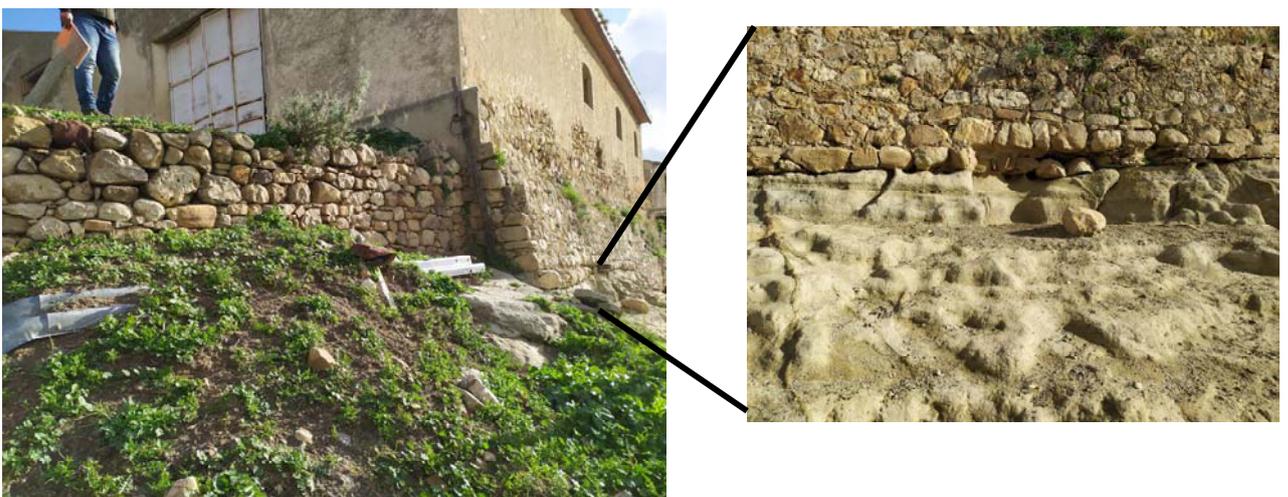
foto del terreno di fondazione e relativo dettaglio stratigrafico prospetto SO
